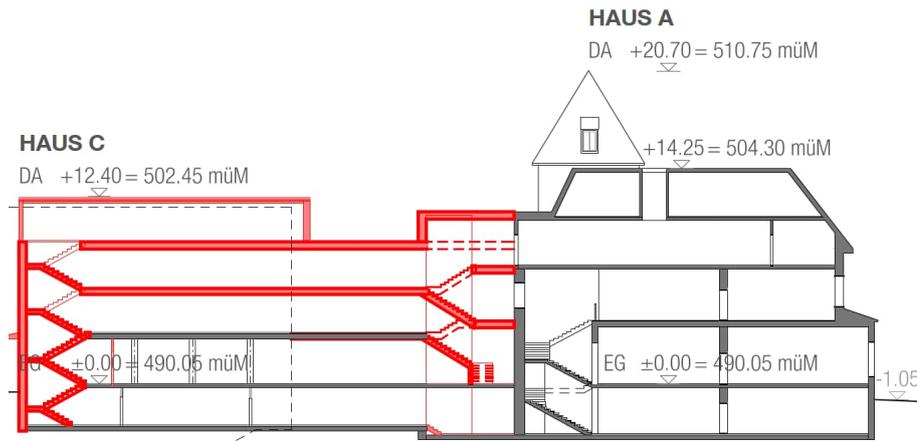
Schnitt durch Haus A&C mit Erhalt bestehender Bausubstanz, Quelle: Richtprojekt von Diener & Diener Architekten
